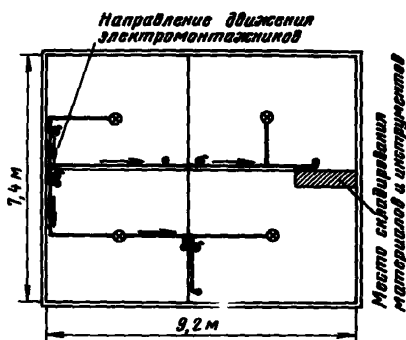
Схема организации рабочего места при монтаже скрытой электропроводки
